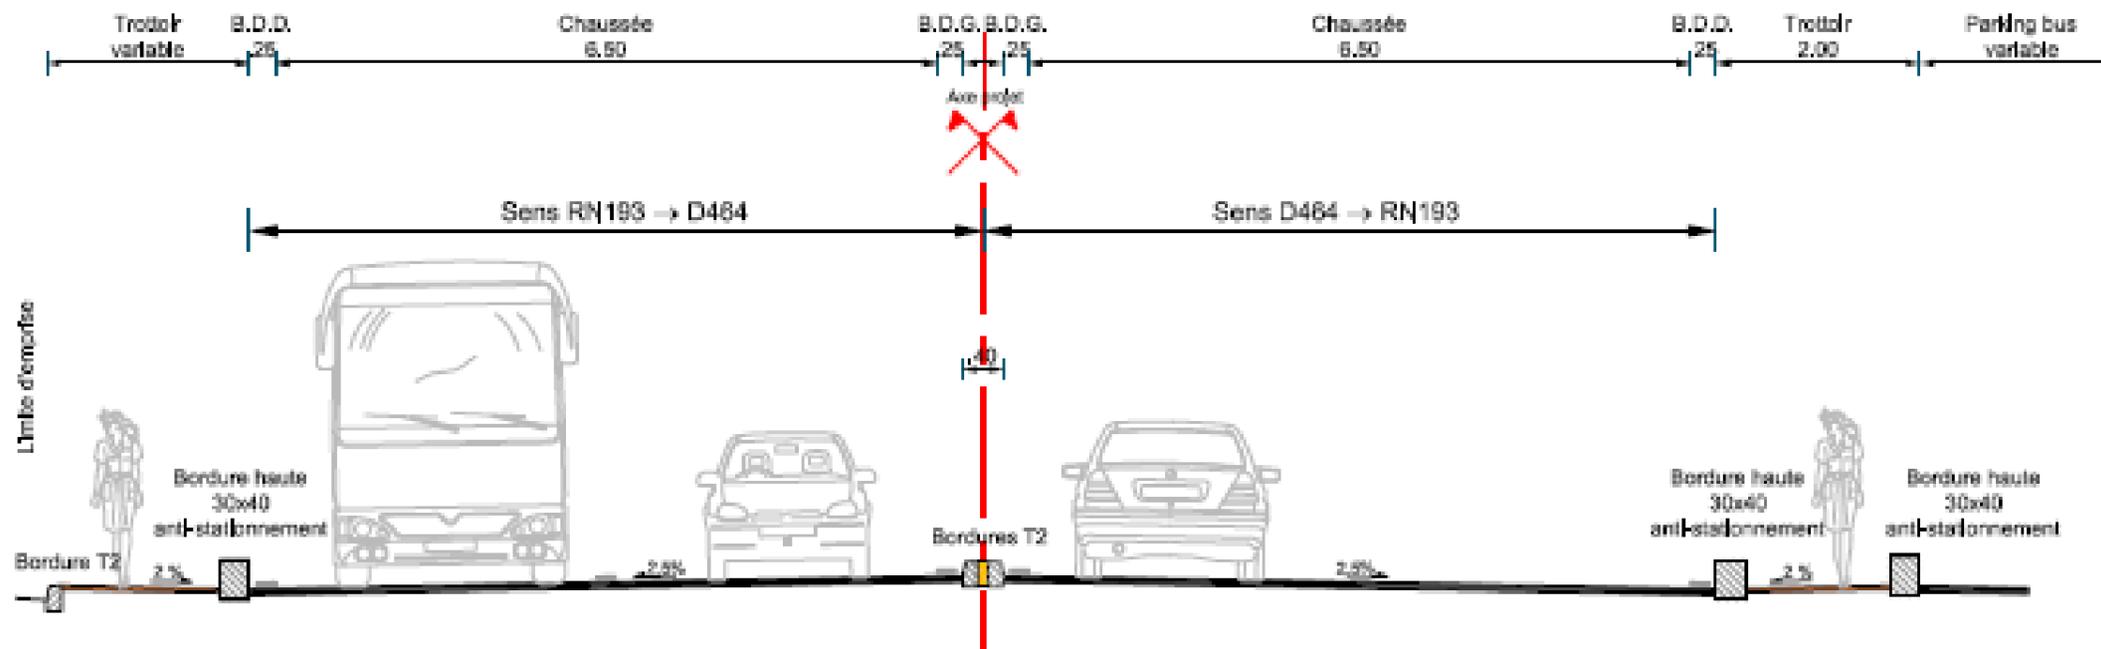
PROFIL EN TRAVERS TYPE DU BARREAU DE LIAISON
